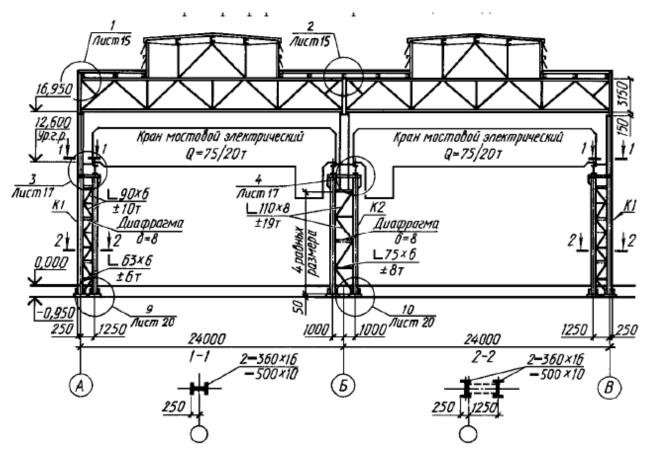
Поперечный разрез здания с металлическим каркасом
